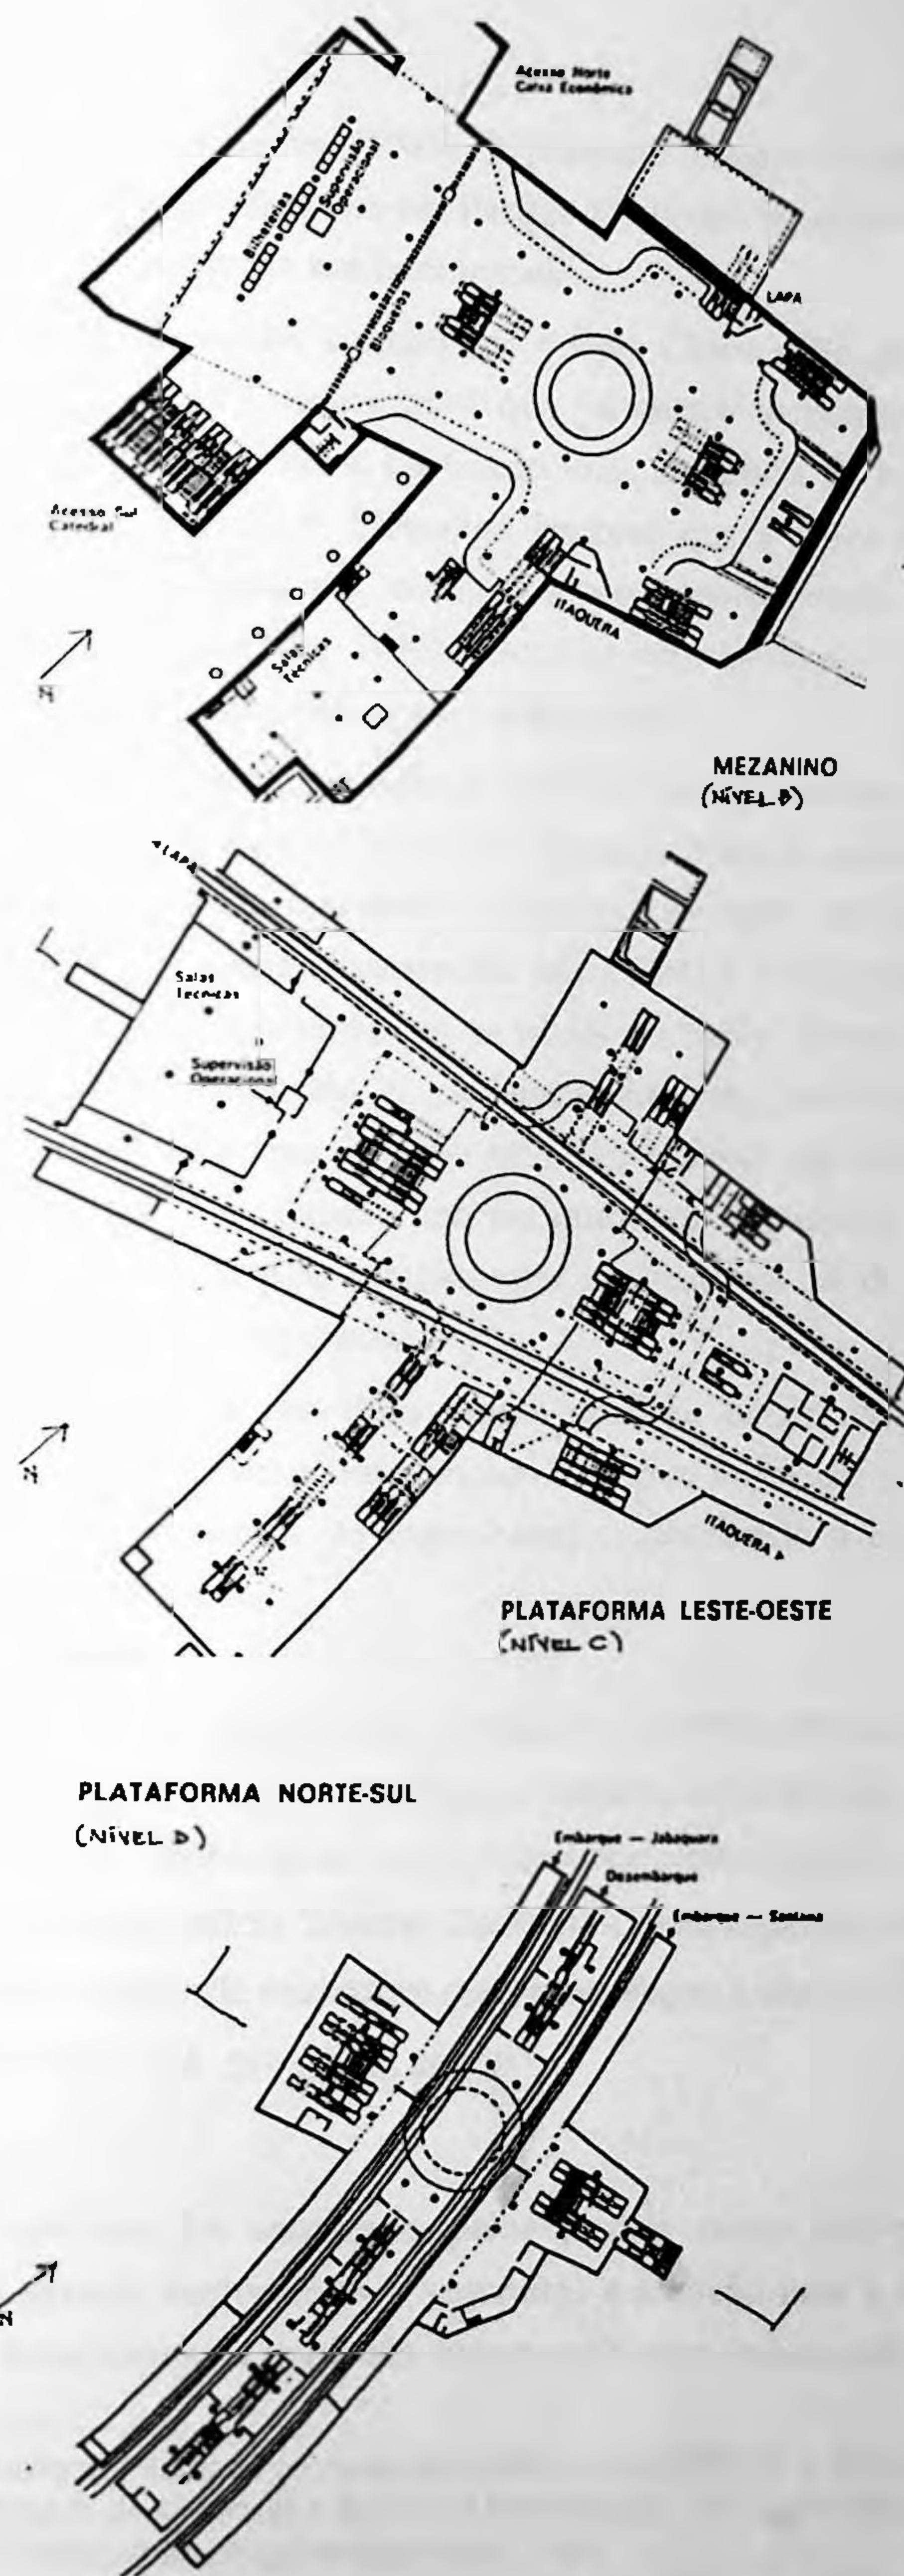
Plantas esquemáticas da estação: mezanino, L/ O e N/S.
